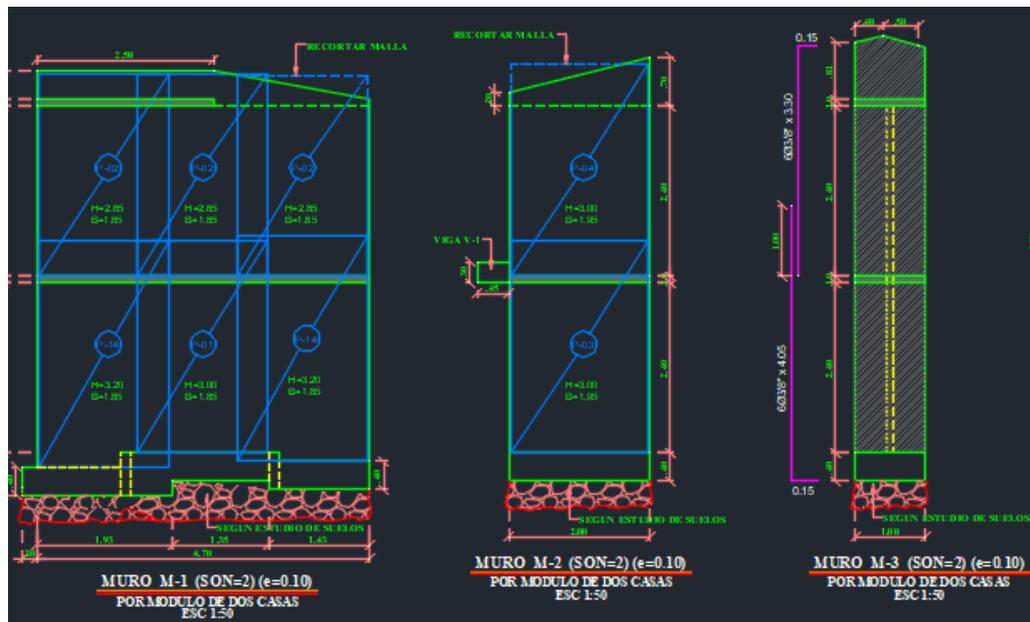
Modulación y Dimensiones Muros M1, M2 y M3 del proyecto Villas del Duruelo.
